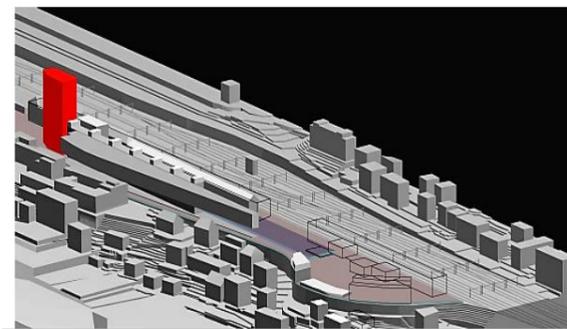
Plan de masse de Tour de l'OFS. Source : www.bauart.ch. Traitement: Auteurs.
